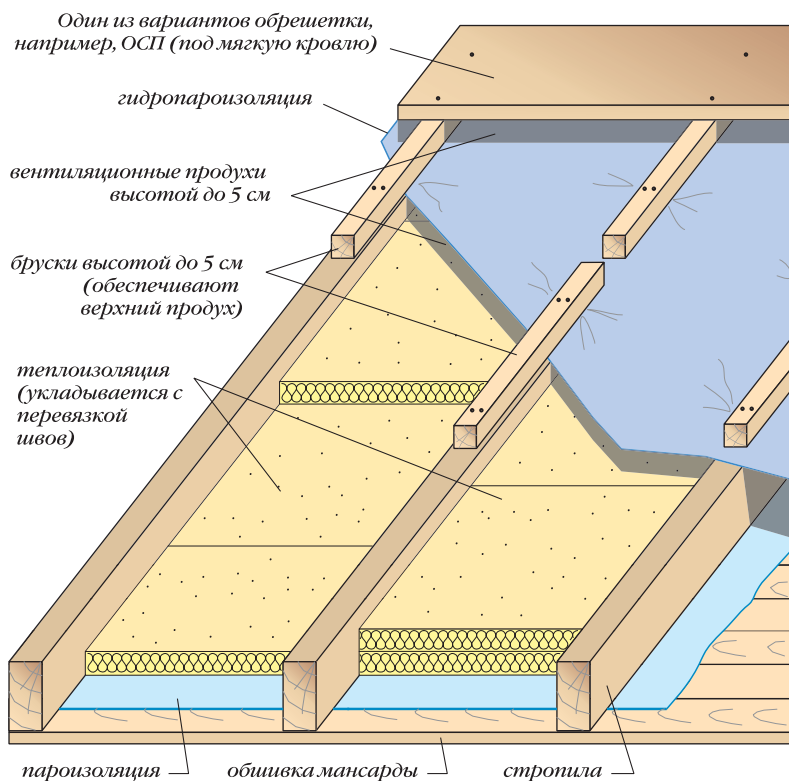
Теплоизоляция минераловатными плитами в межстропильном пространстве
